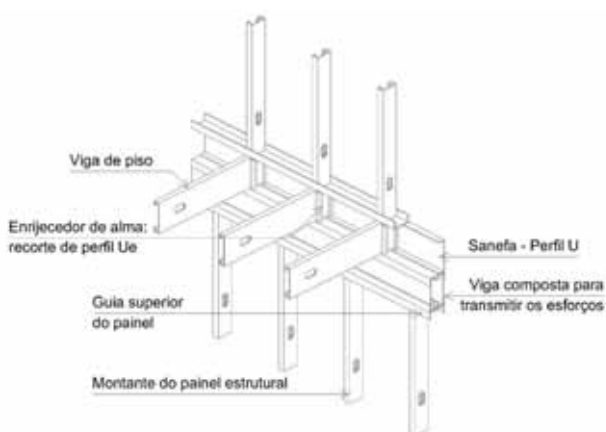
Viga de distribuição da carga do piso para os montantes
